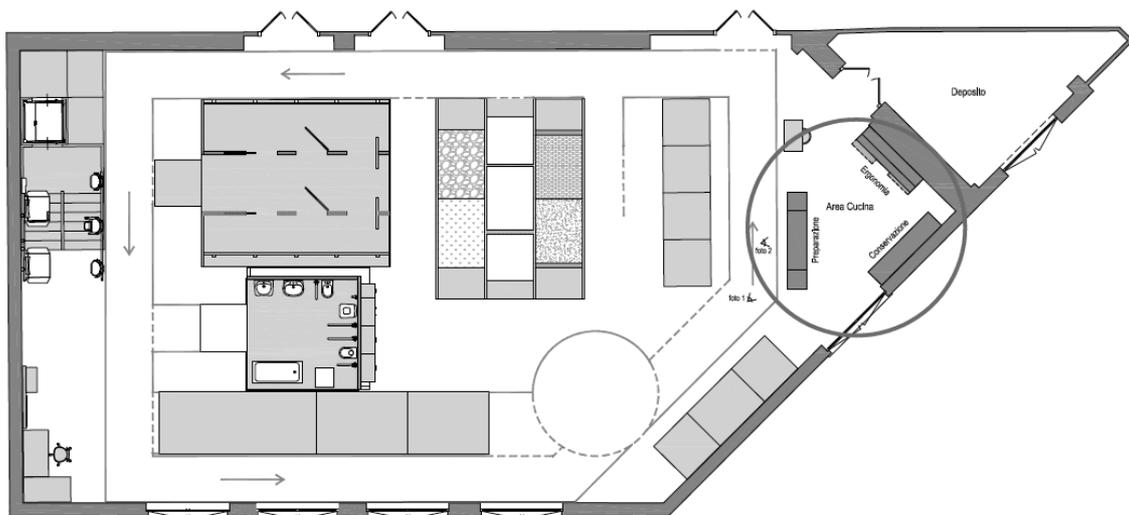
Planimetria Palestra AUSILIA - Area Cucina
